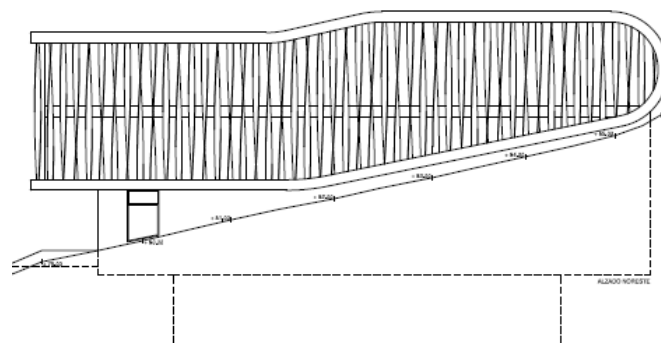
plano alzado de la fachada noreste semienterrada.
